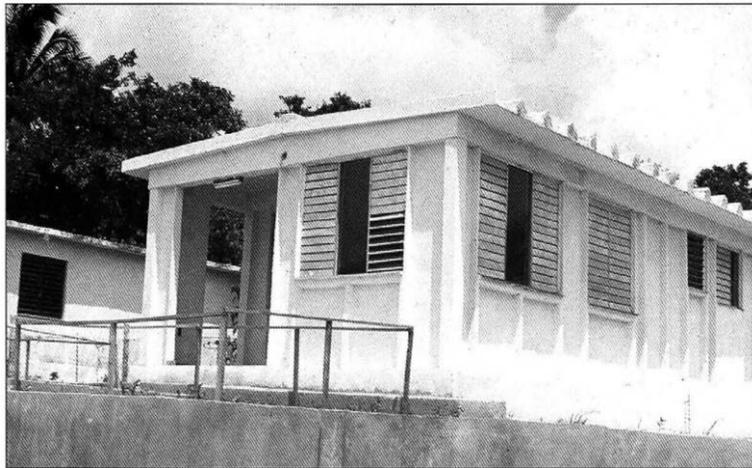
Primera vivienda de ferrocemento construida en pinar del Río, Cuba.
